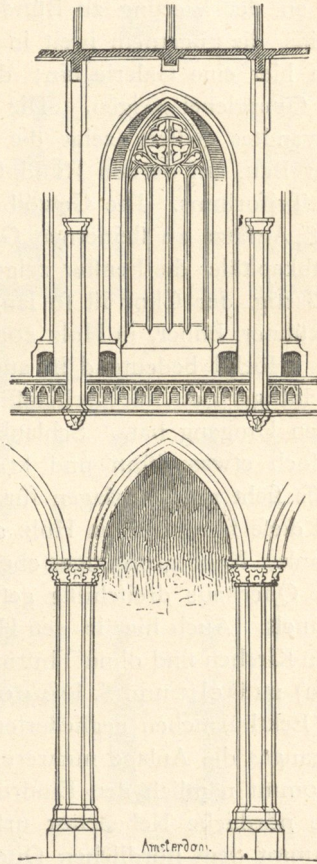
Liebfrauenkirche zu Amsterdam. System. (Nach Essenwein.)
